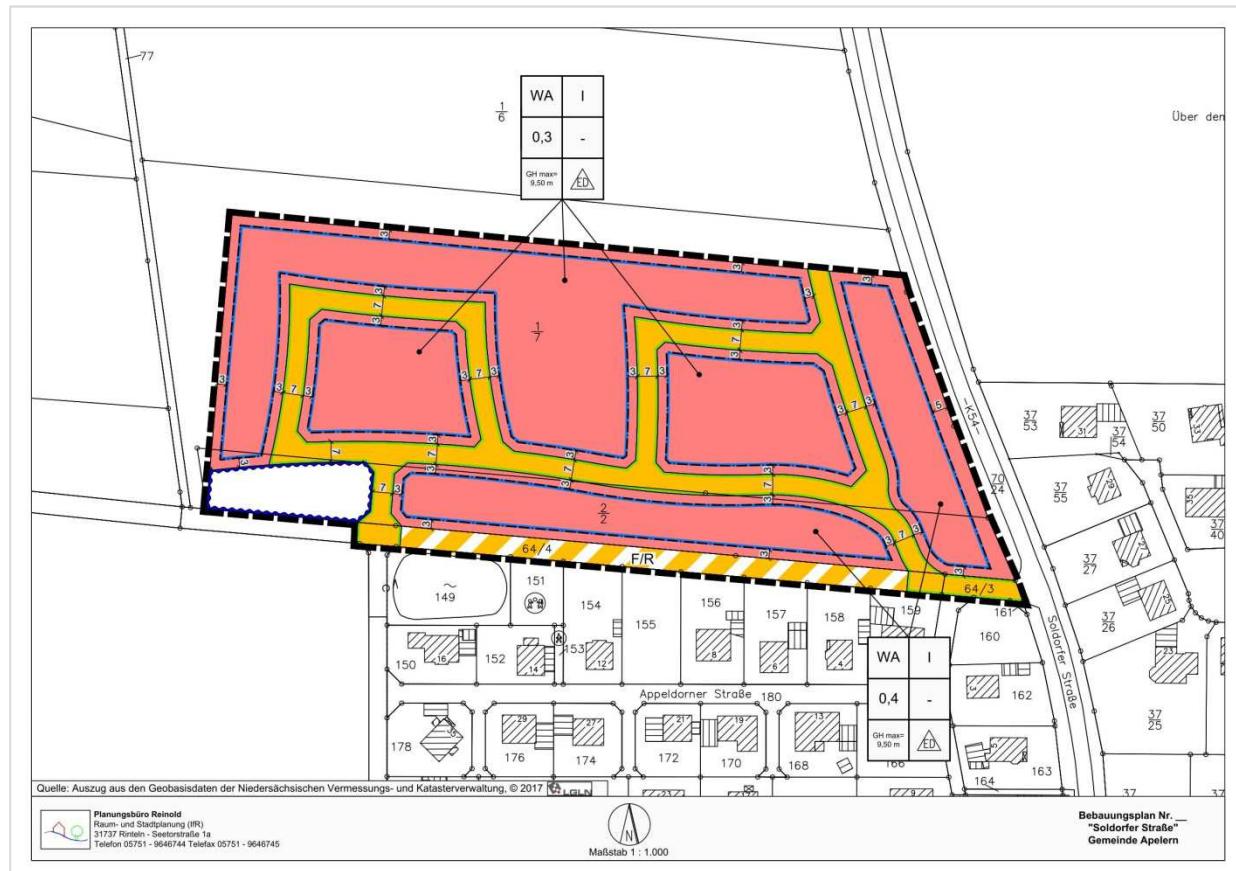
Bebauungsplan „Solderfer Straße“, zeichnerische Festsetzungen (Entwurf, Quelle: Planungsbüro Reinold, Stand: Mai 2019)
